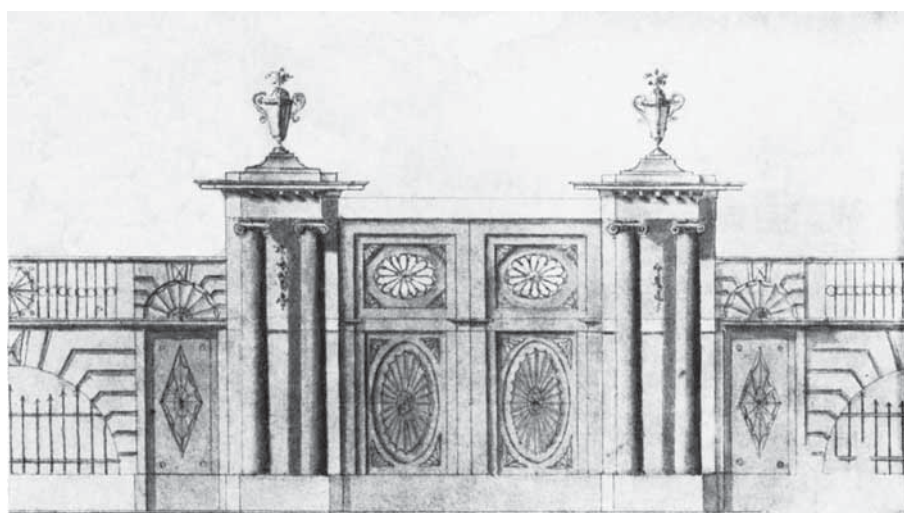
Москва. Дом Ермолова на Тверской. Отстроен после 1773 г. с использованием стен более раннего здания [1, с. 38]
